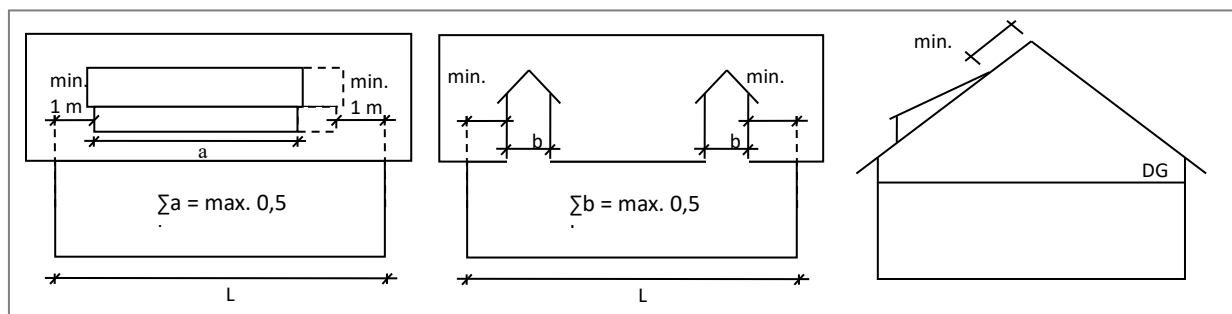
Darstellung zur gestalterischen Festsetzung der Dachgauben
